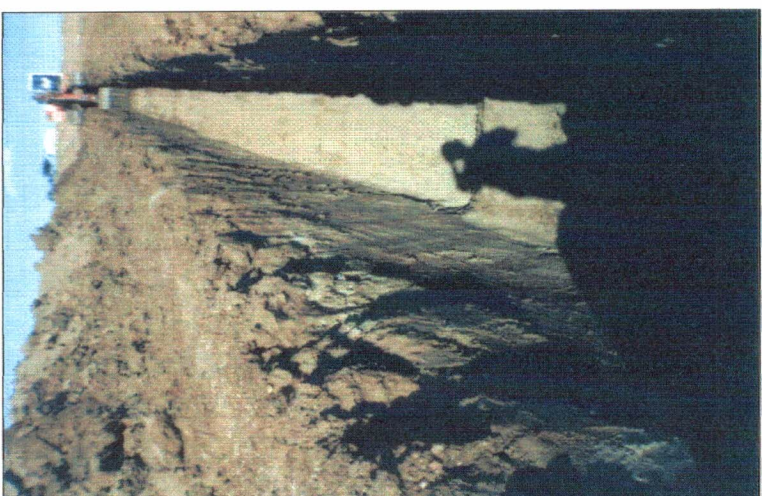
Execução do filtro vertical entre est. 06 à 22; Detalhe das paredes do maciço escavado.
